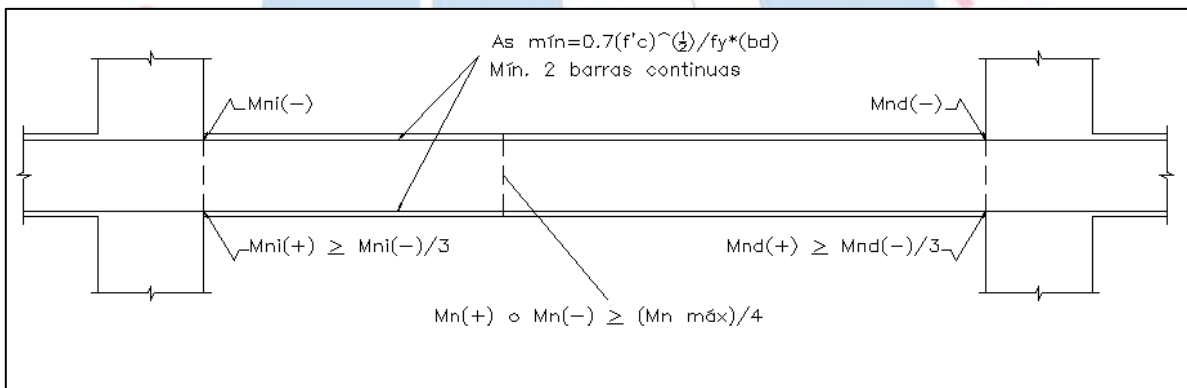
Disposiciones para el diseño por flexión de vigas sismorresistentes en edificios con sistema estructural de muros.
